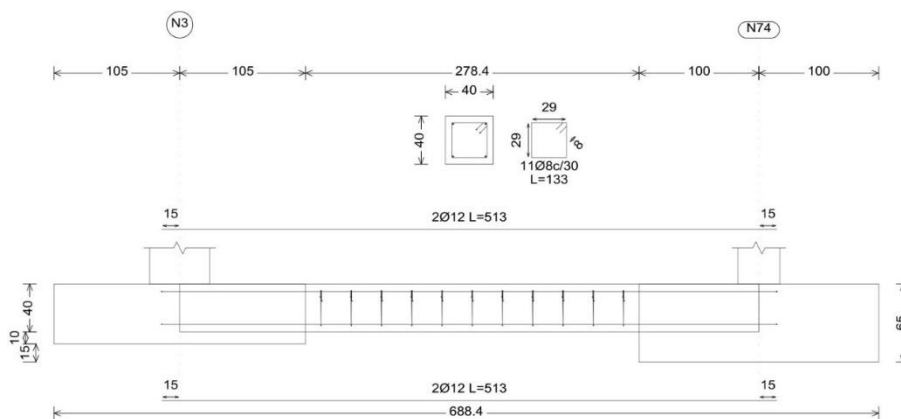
Viga de atado de los pilares de pórticos de fachada. Fuente: Elaboración propia a partir de CYPE 3D
